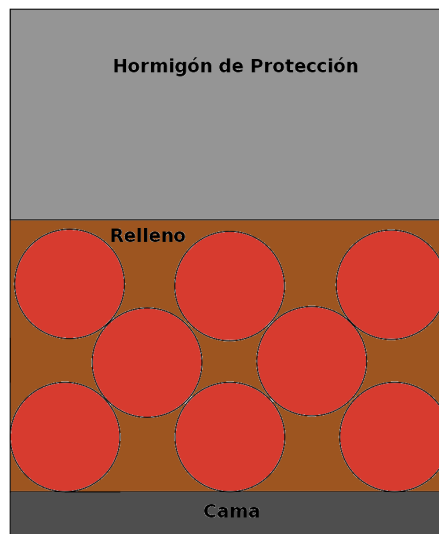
Sección transversal de la zanja para iluminación y video-vigilancia.
